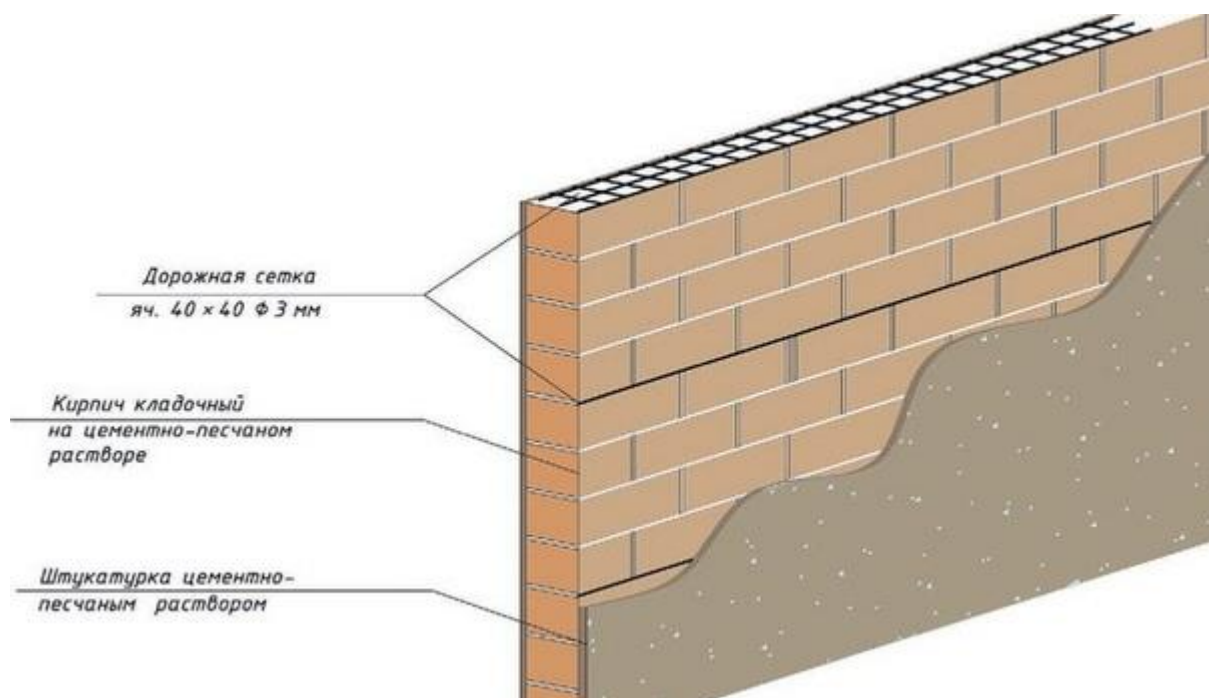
Цегляна перегородка (принципова схема)
